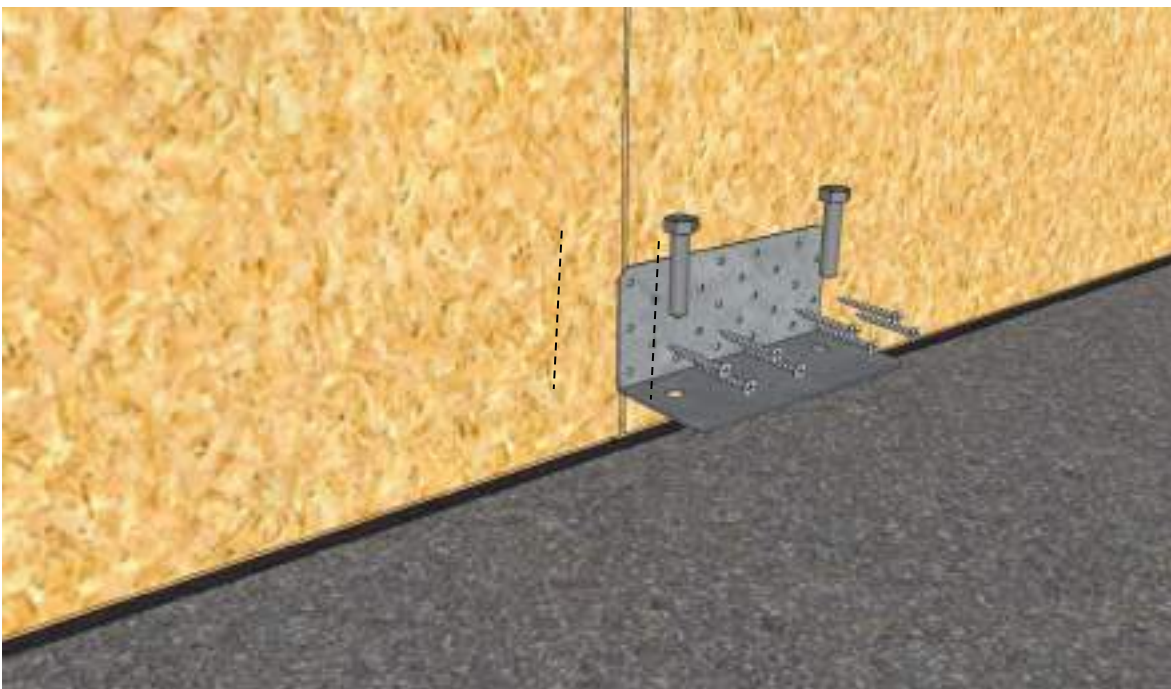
Mise en œuvre d'une équerre de reprise du glissement au droit de la jonction des panneaux, pour assurer notamment la continuité mécanique des traverses basses
